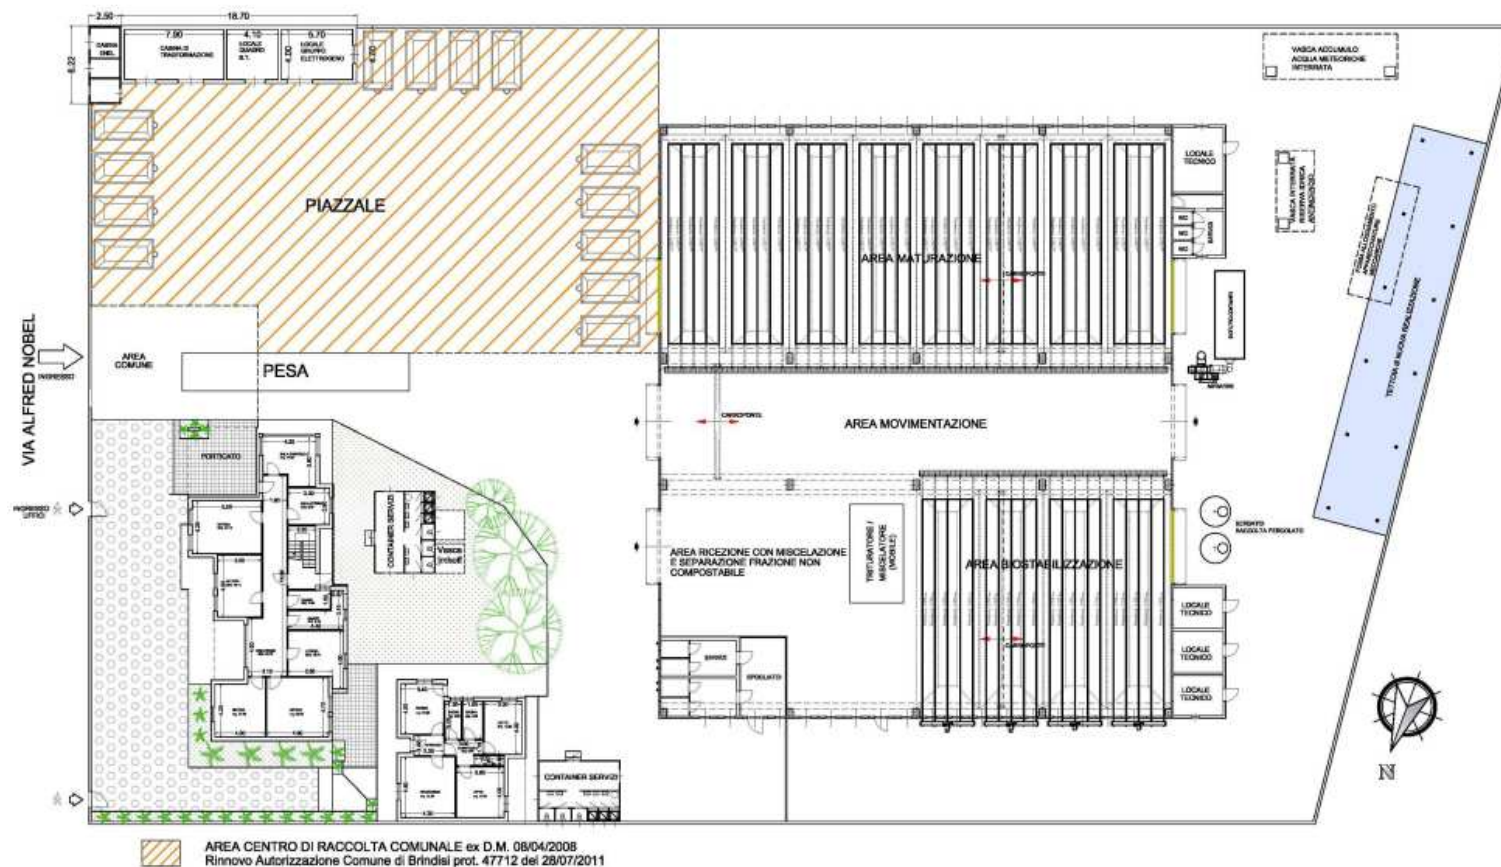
Planimetria dell'impianto con le zone interessate alla variante di progetto
